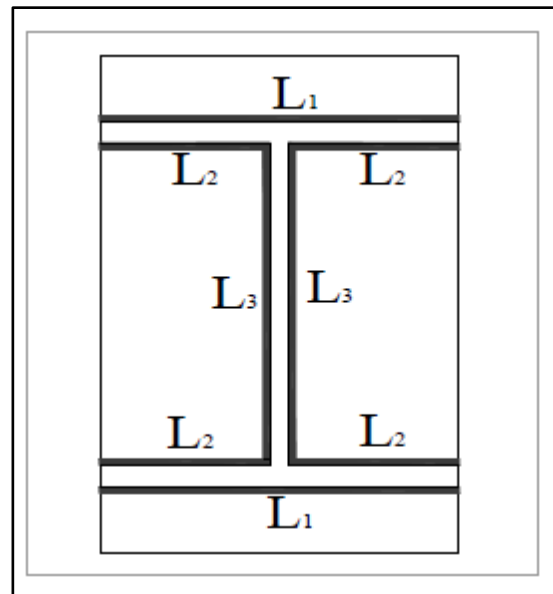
Assemblage soudé traverse-platine. [5]
